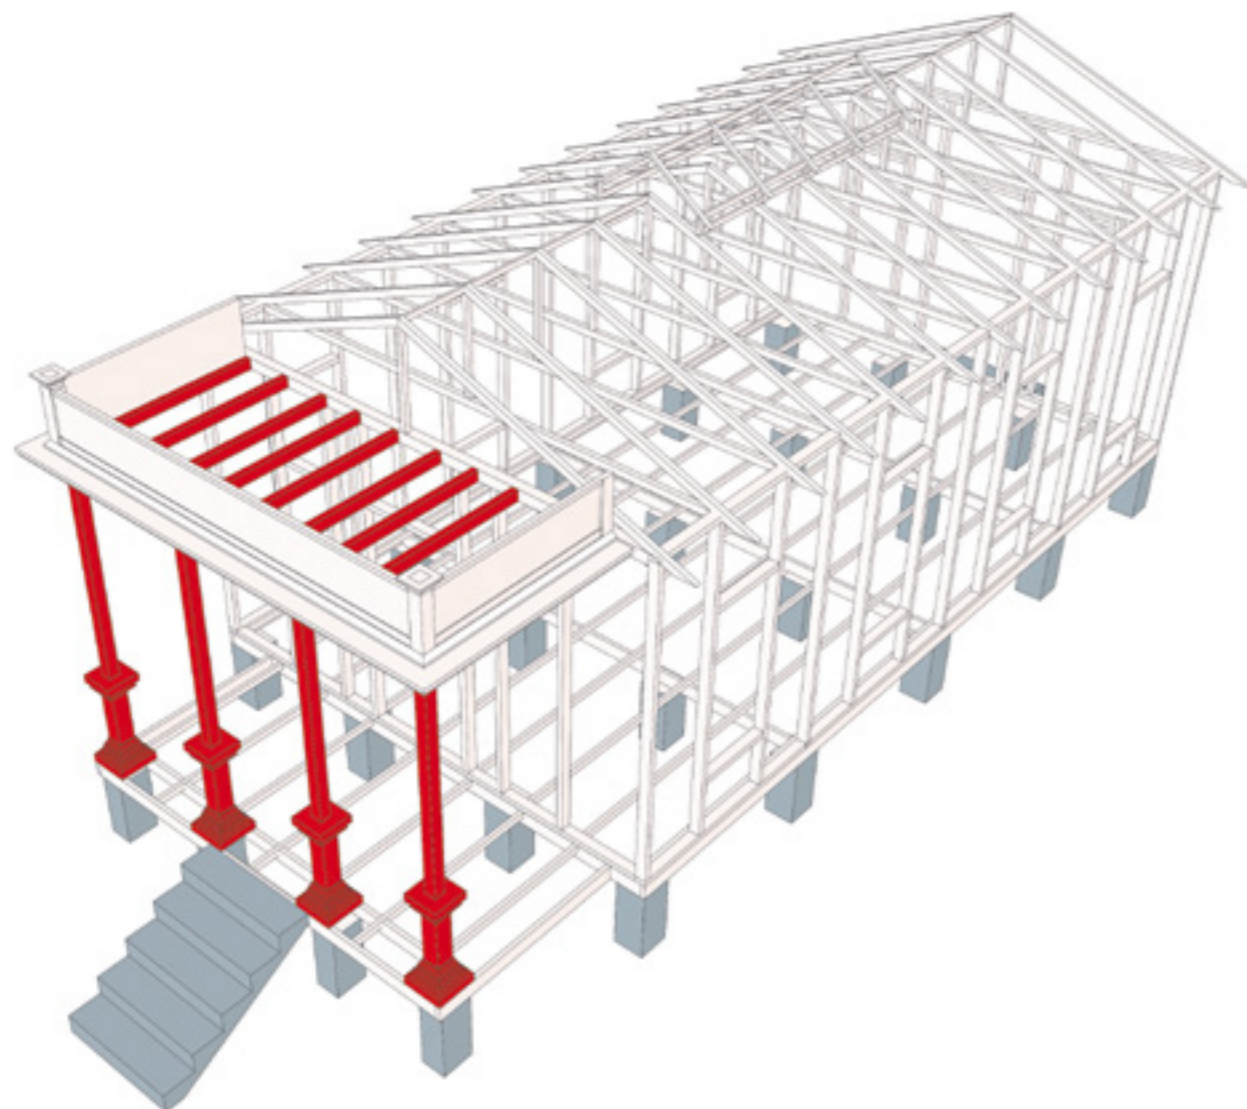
Vivienda concebida a partir de la tipología de la barraca de madera importada de los Estados Unidos, a la que se adicionó un portal ensamblado con techo plano.
